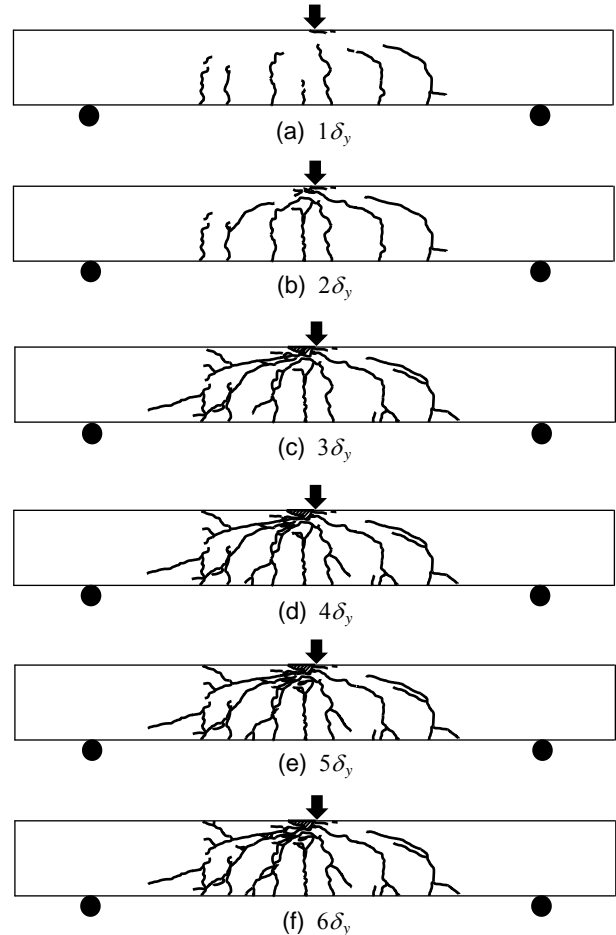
曲げ破壊型 F 供試体のひび割れ図
